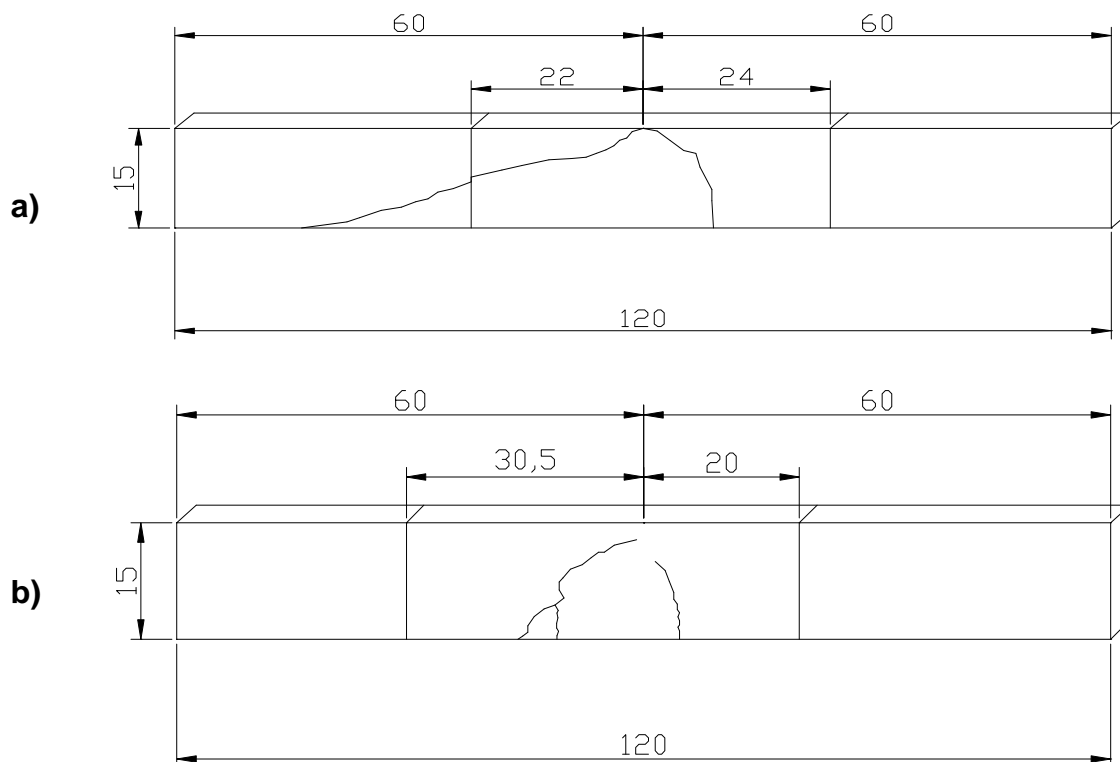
Esquema de fisuración de vigas después de la aplicación de carga mecánica, medidas en cm. a) viga 4 b) viga 5
